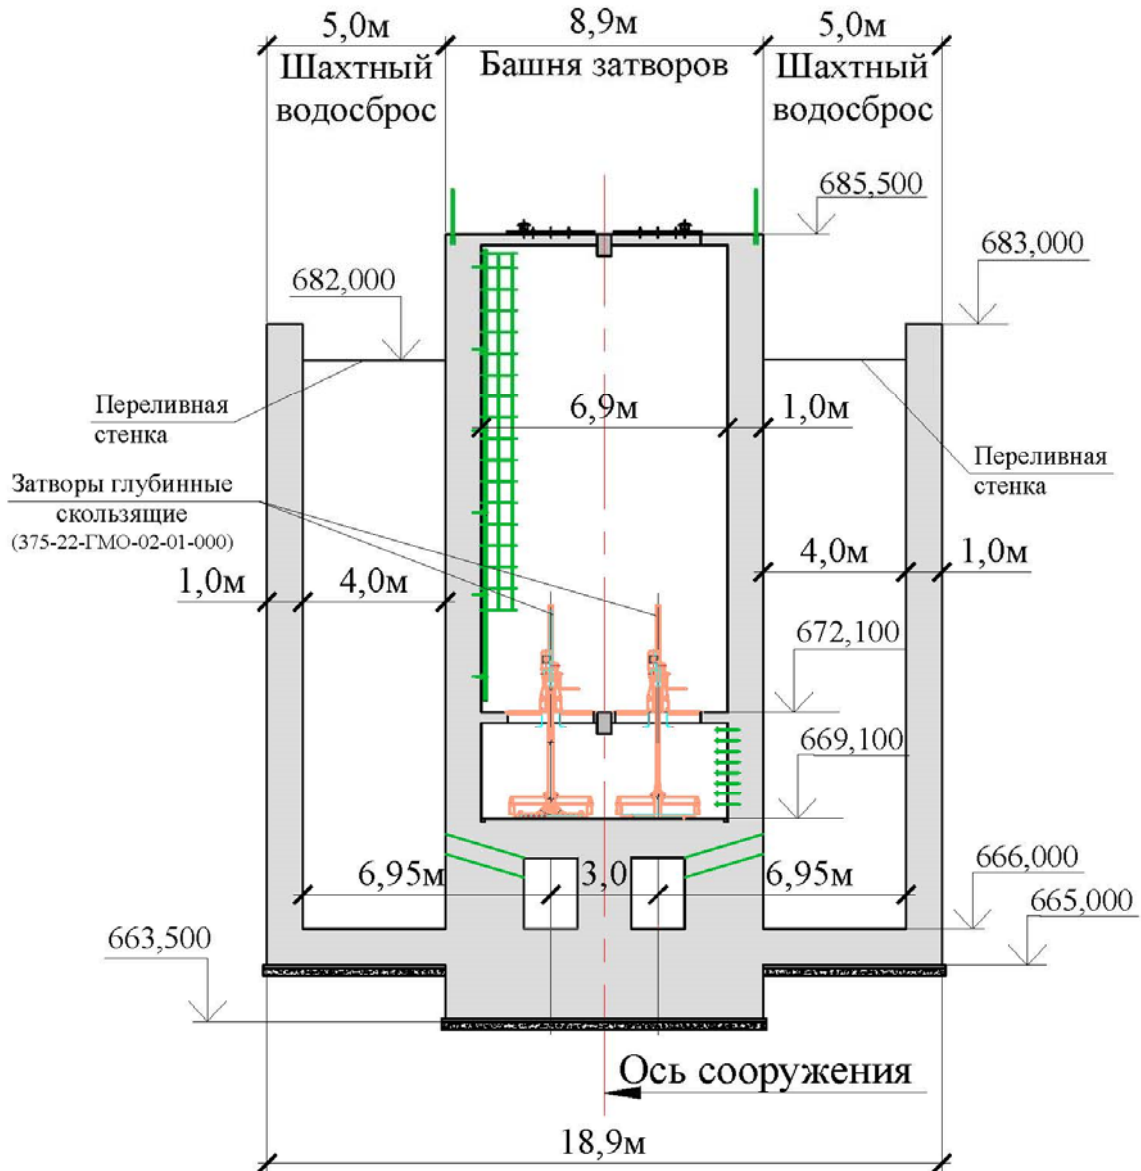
Поперечный разрез по башне затворов с шахтным водосбросом
